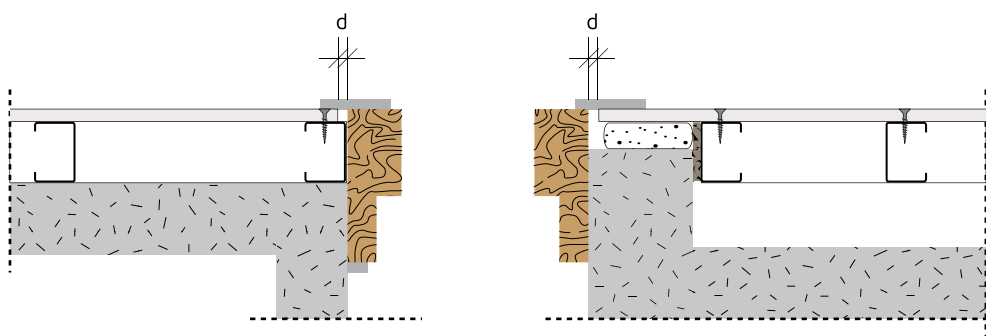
Aplicação de elementos construtivos que definem as aberturas.
